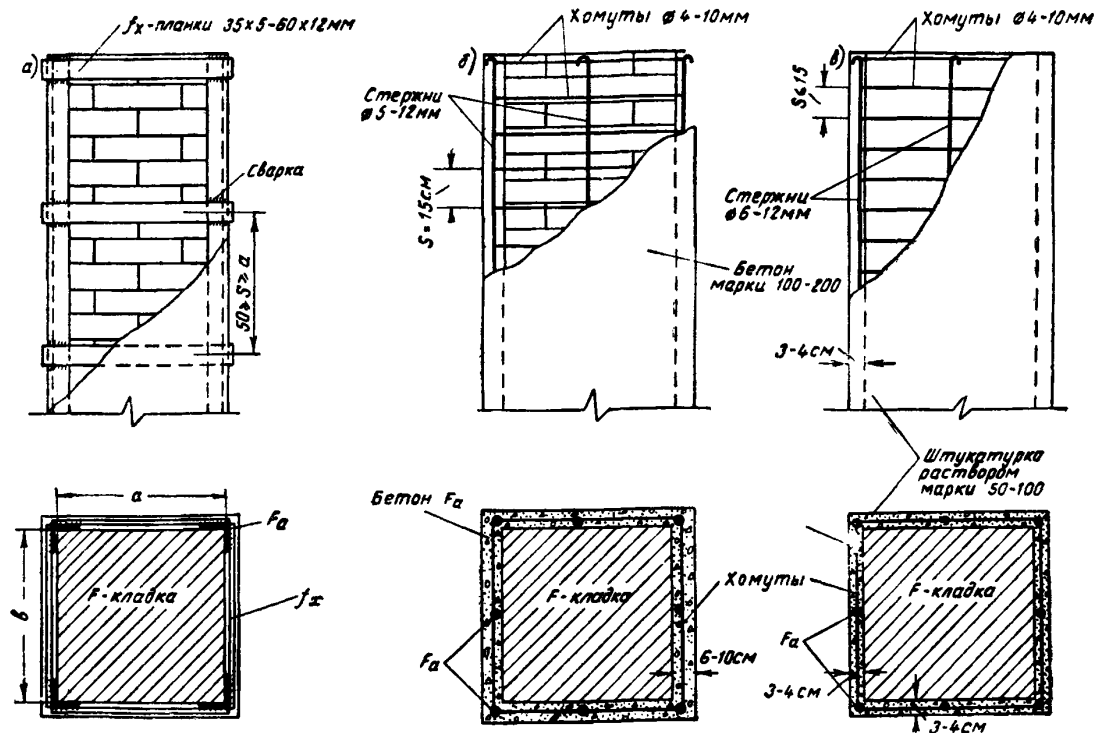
Схема усиления кирпичных столбов обоймами различных типов
